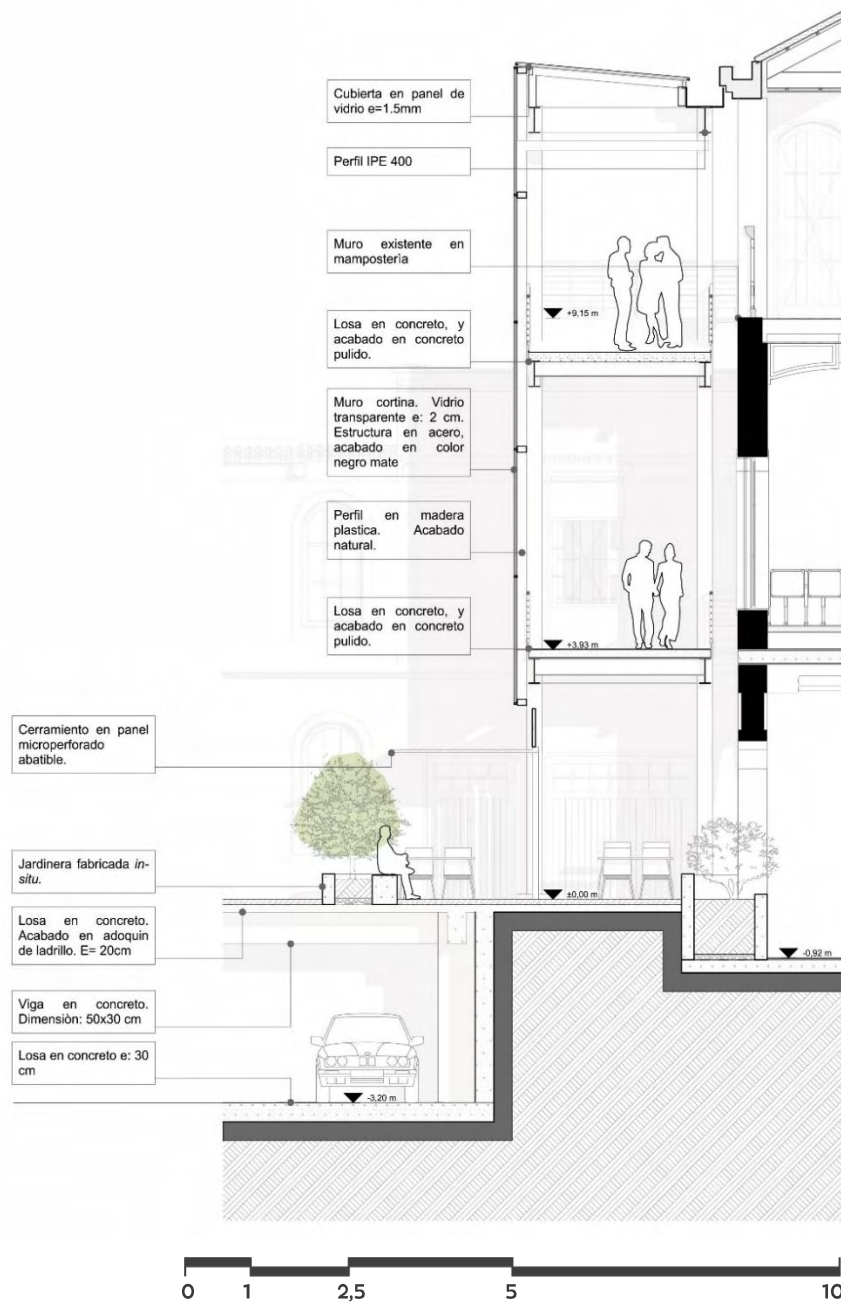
Corte por fachada Ala oriental (CEILAT). Fuente: Elaboración Propia.
